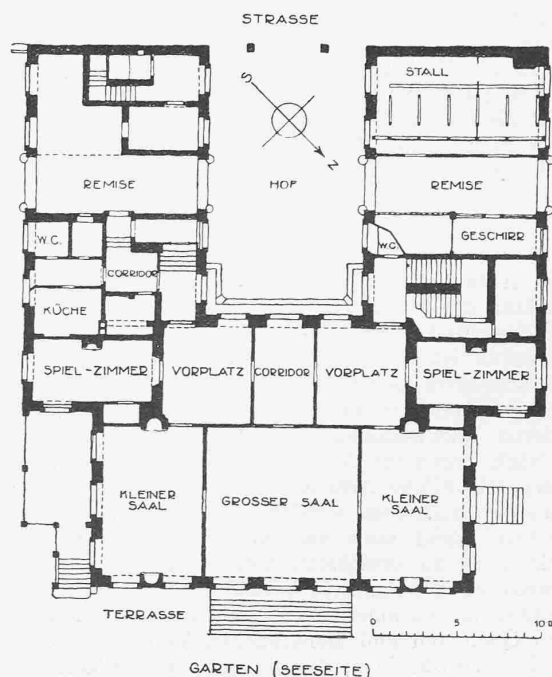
Erdgeschoss-Grundriss des Muraltengutes, vor dem Umbau.
